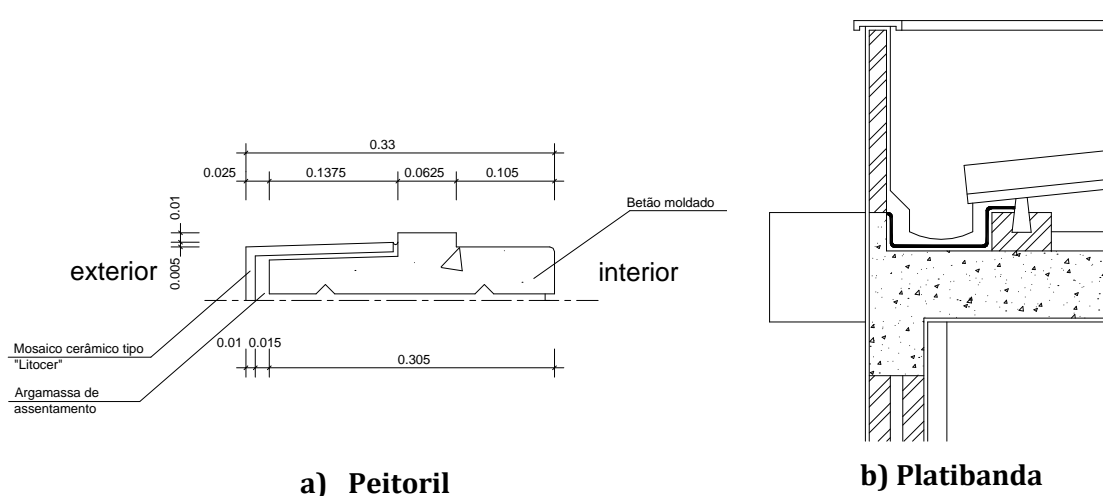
Pormenor construtivo do peitoril e da platibanda.
